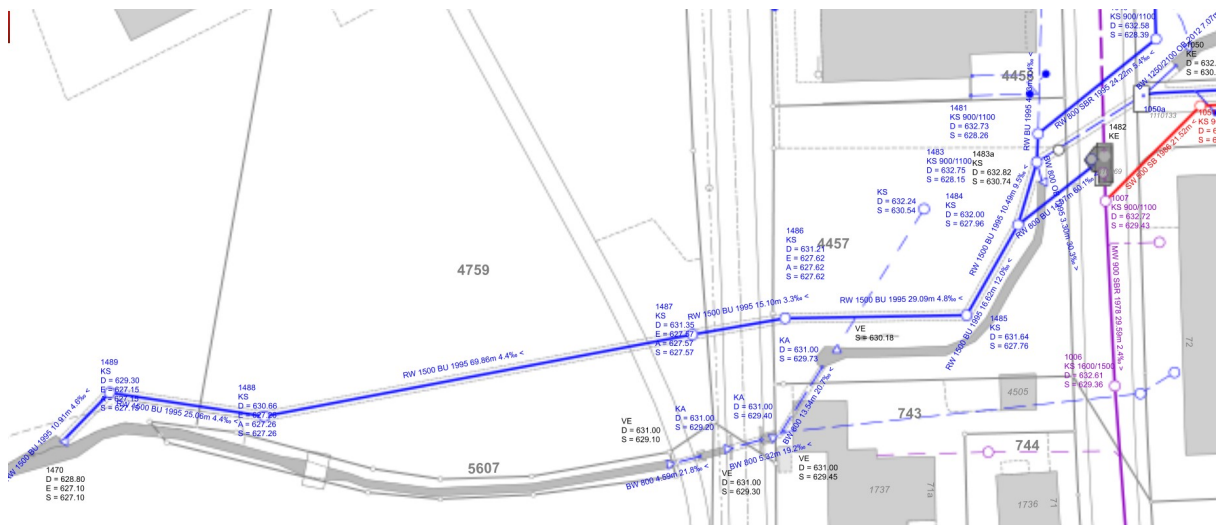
; Ausschnitt Abwasser Werkplan geoportal.ch Okt. 2019 (ohne Massstab)
